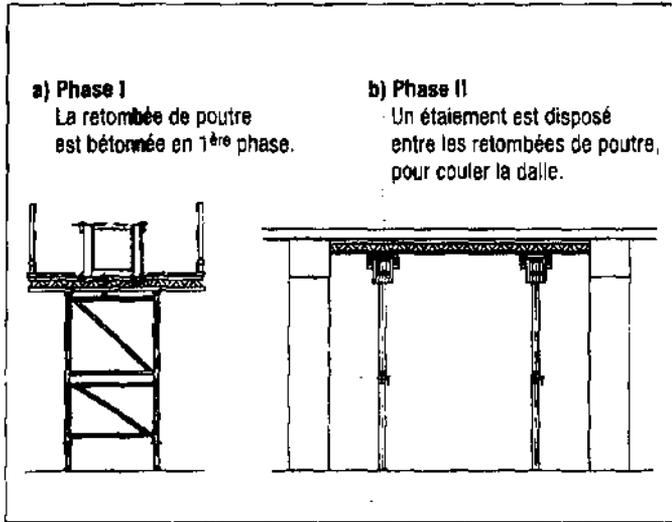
Coulage de la retombée avant réalisation de la dalle.
